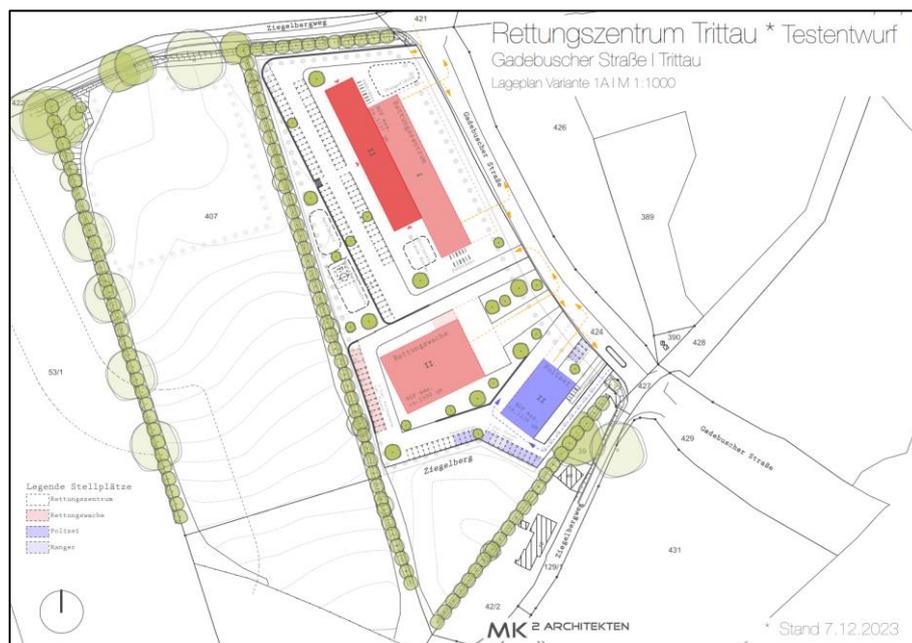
Lageplan V1A Testentwurf (MK2 Architekten, Stand: 07.12.2023)
